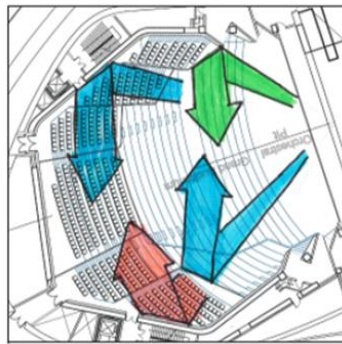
توضح مسقط أفقي للطابق الارضي للقاعة
